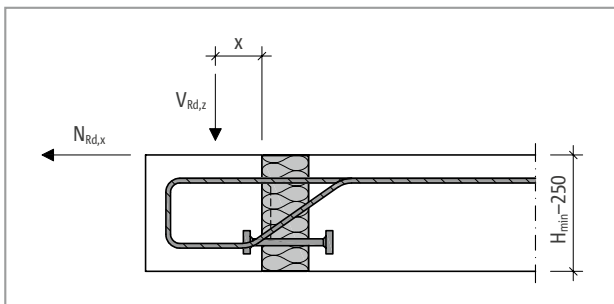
Schöck Isokorb® T Typ O: Abstand des Lasteinleitungspunktes x (Lastabstand)
